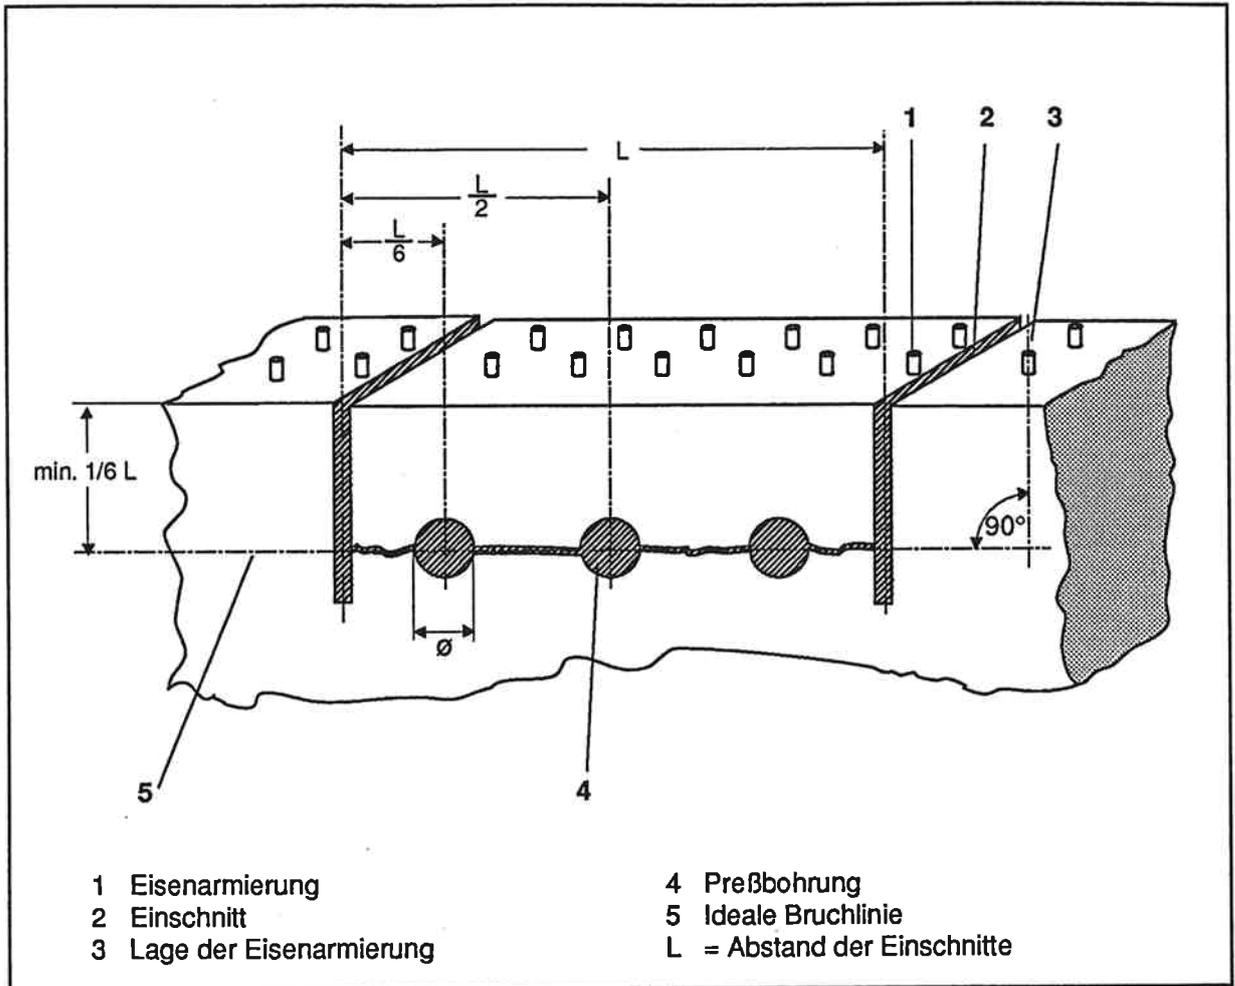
Preßbohrungen für 3 Preßwerkzeuge
